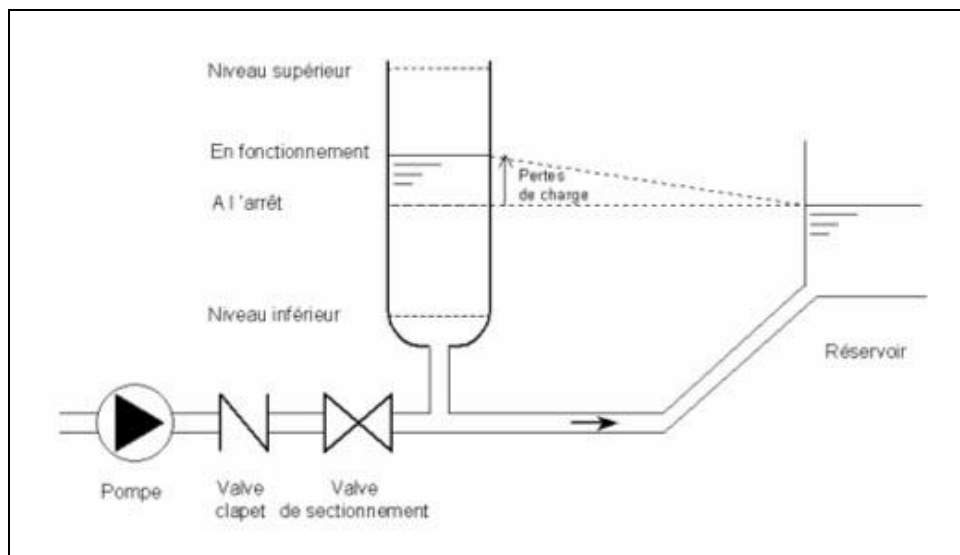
Cheminée d'équilibre sur une conduite de refoulement.
